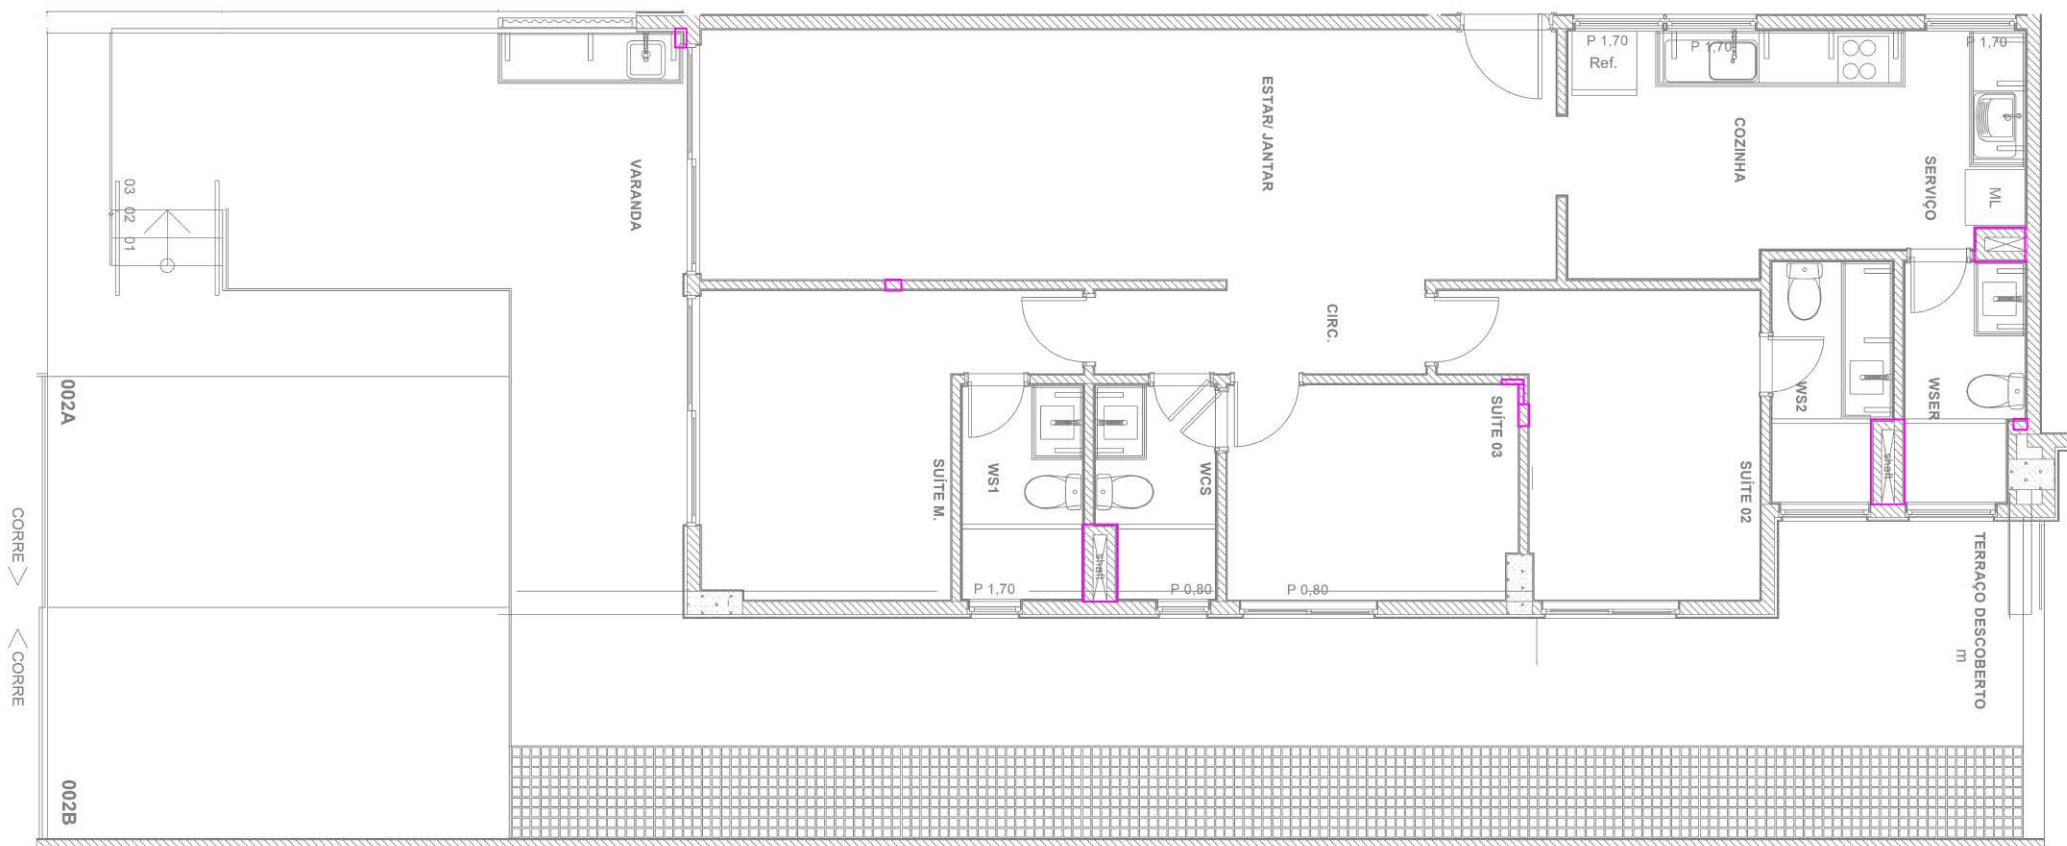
Planta com localização das prumadas sanitárias e pluviais (retângulos na cor magenta) do apartamento 002
